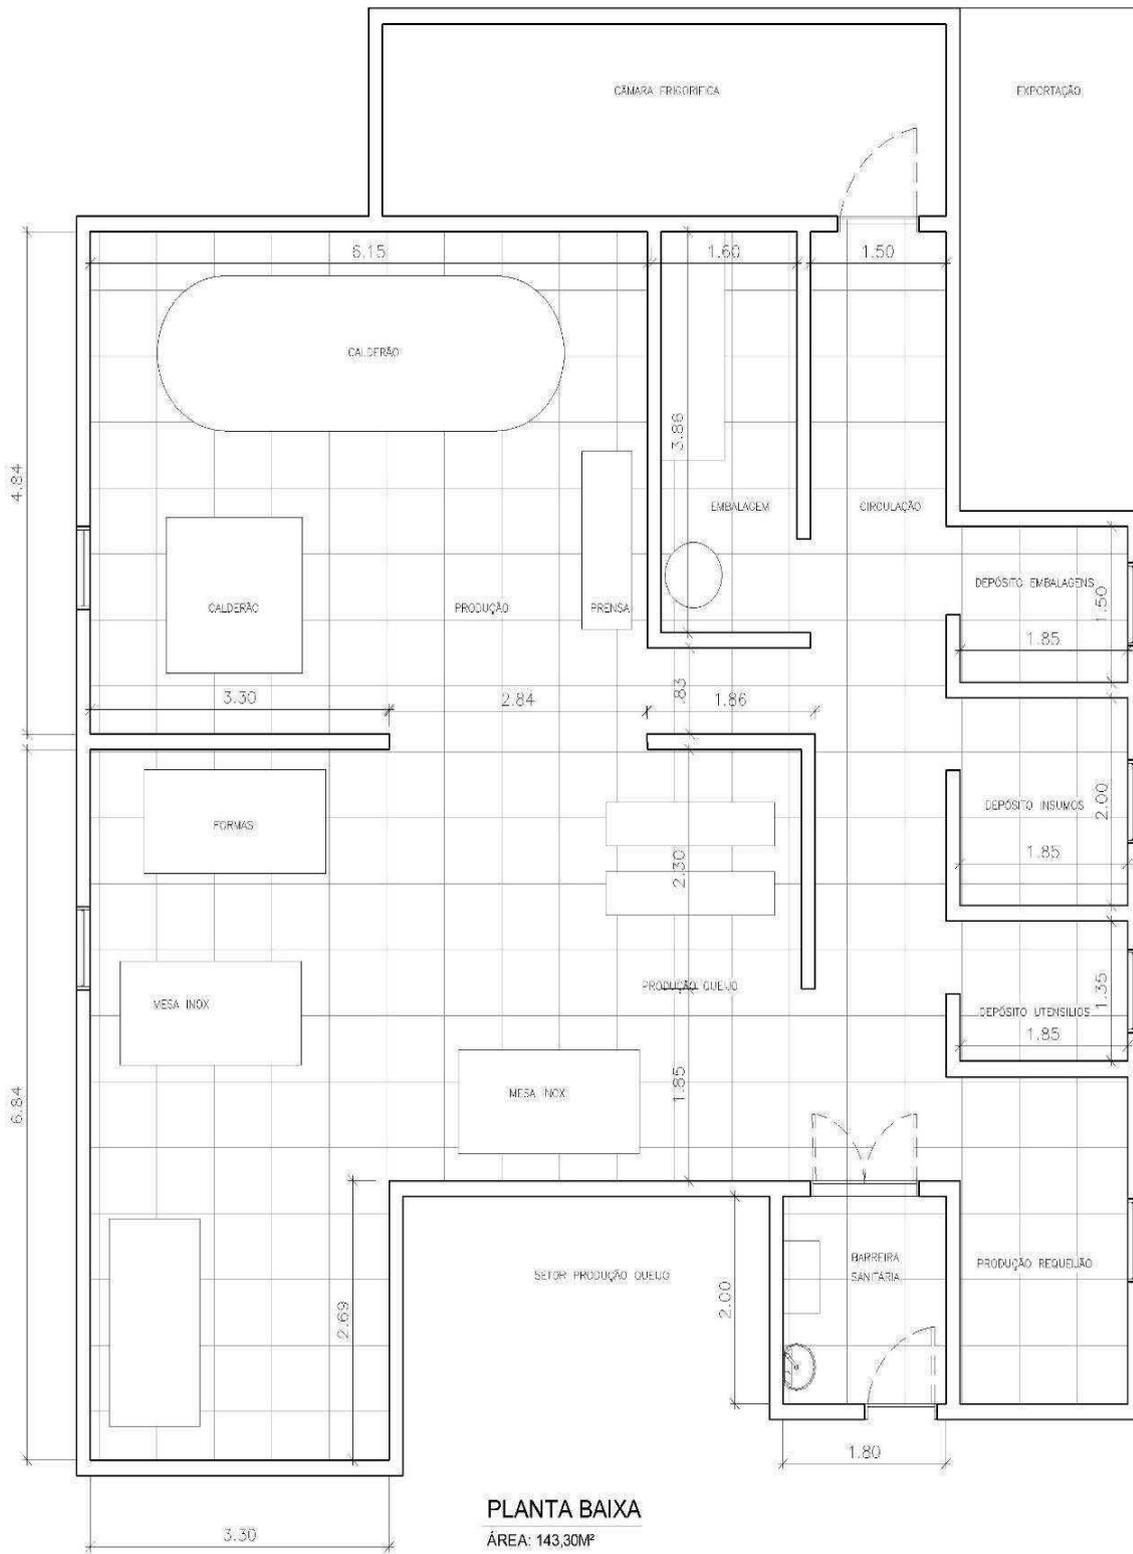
Planta baixa da Queijaria K. Fonte: Autora, 2021.
